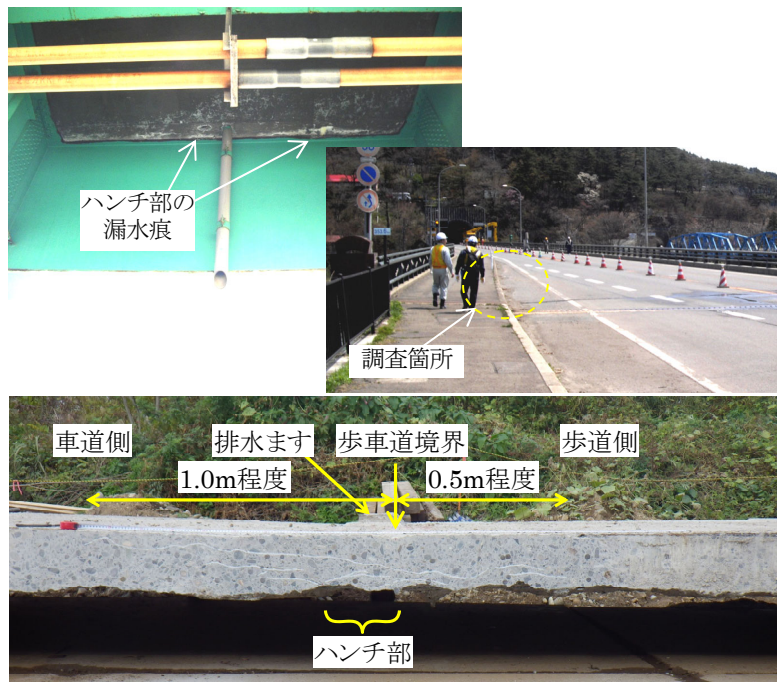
歩車道境界付近の水平ひび割れ⁷⁾
